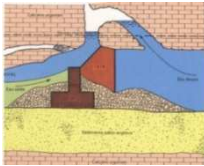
coupe galerie au droit du barrage, gallery cross-section at the dam level
